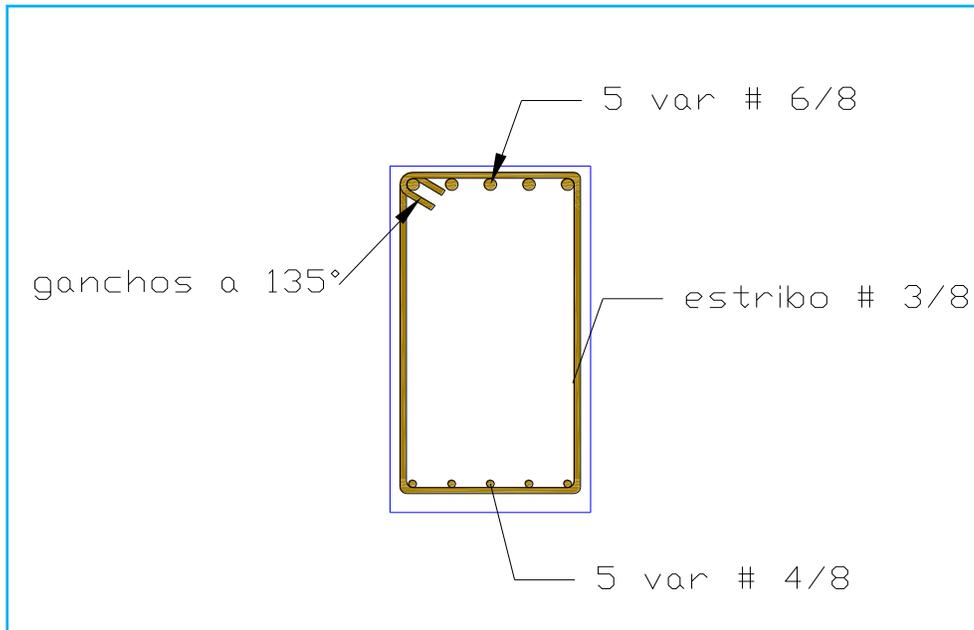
esquema de la distribución del acero para la trabe en los primeros 17 m, a partir del apoyo empotrado.
